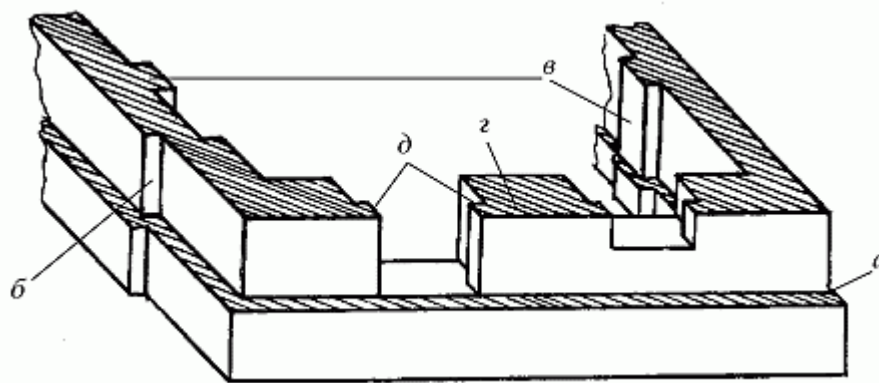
Детали каменных конструкций: а – обрез; б – уступ кладки; в – пилястры; г – простенок; д – четверть
